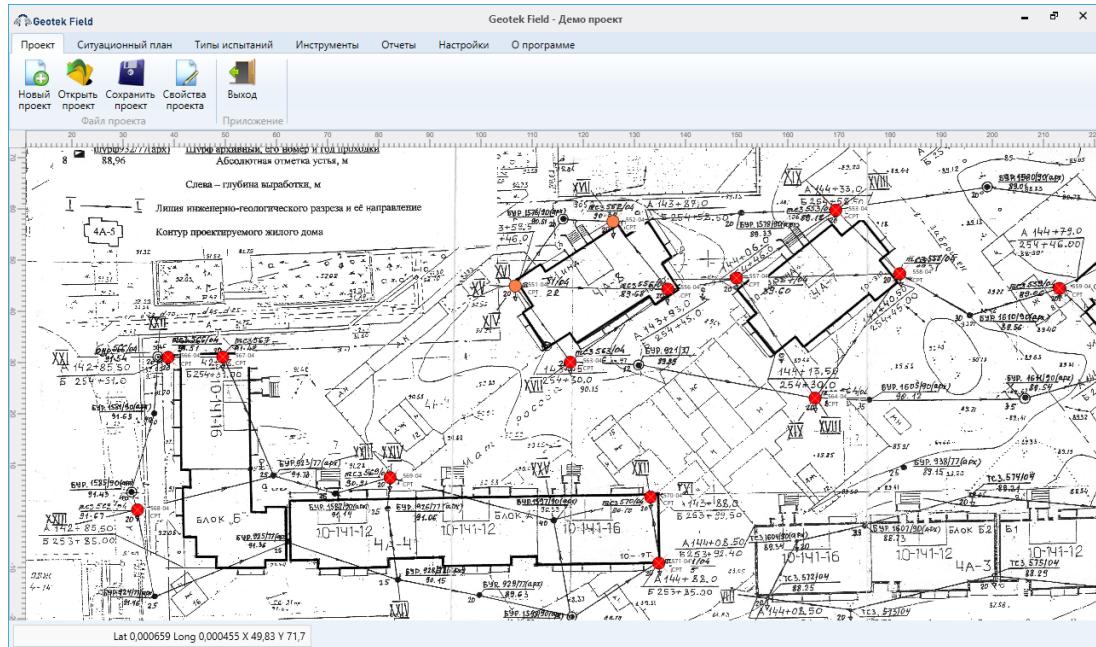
Отображение введенного плана здания с местами испытаний
